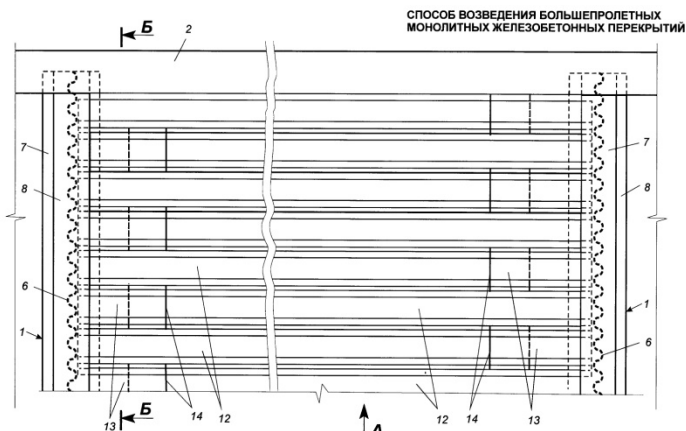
Фрагмент большепролетного перекрытия с двумя двутавровыми балками и набором опалубочных элементов (вид сверху) [3-4], где:
